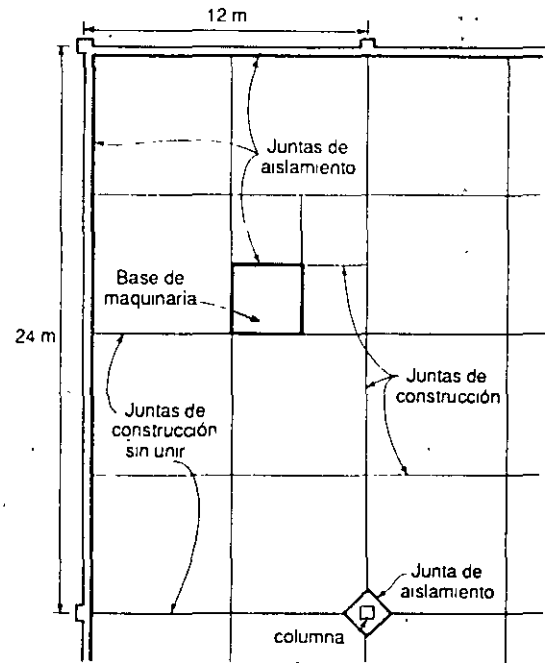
Disposición típica de las juntas en un piso de concreto de 20 cm de espesor.
